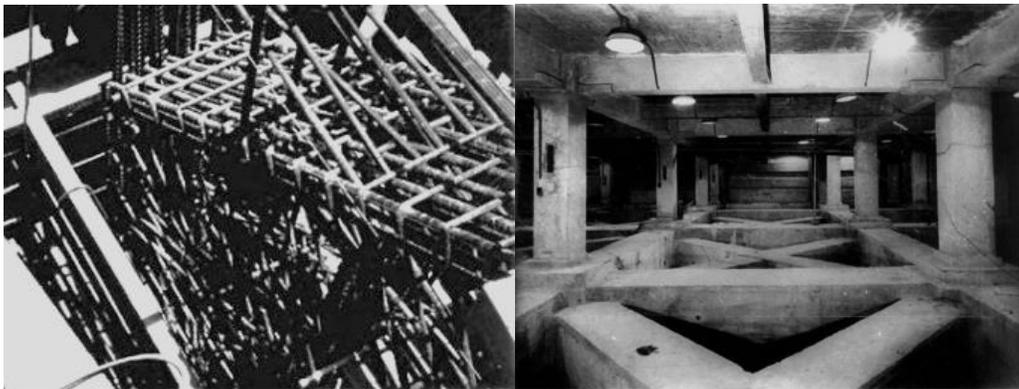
ARMADO DE LAS TRABES DE CIMENTACIÓN Y CONTRAVENTEOS. (ZEEVWOLFF, 2016)
